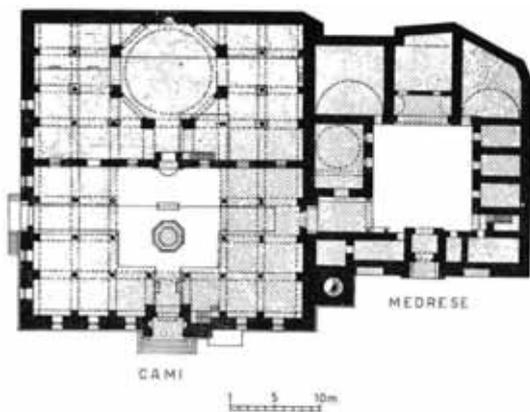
Grundriss der "Großen Moschee" und Madrasa, Manisa
